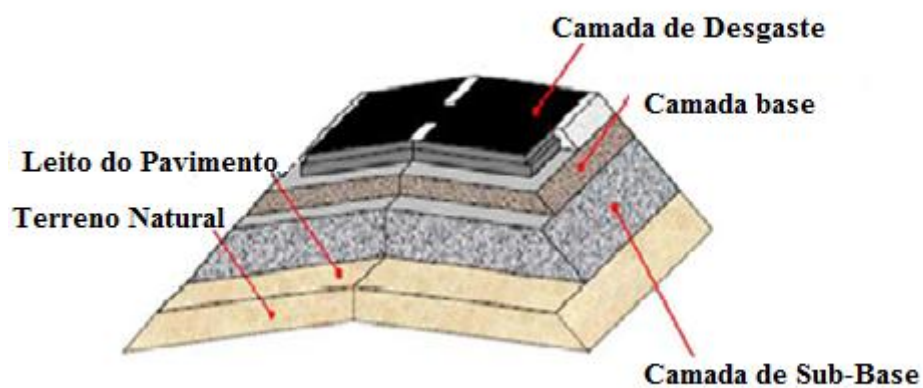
Pavimento Flexível Tipo (Fonte: PIARC, 2009)
